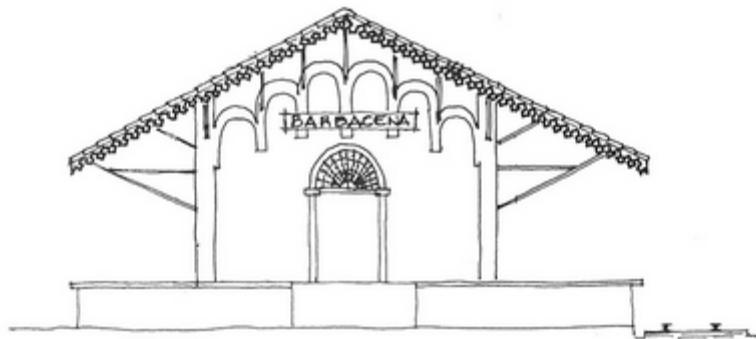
Modelo da estação construída em Barbacena, MG, em 1880, pela EF D. Pedro II.
